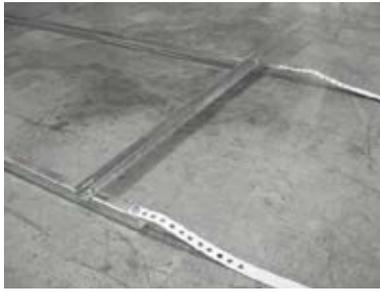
Montaje sobre cubierta inclinada (1) captadores plano
